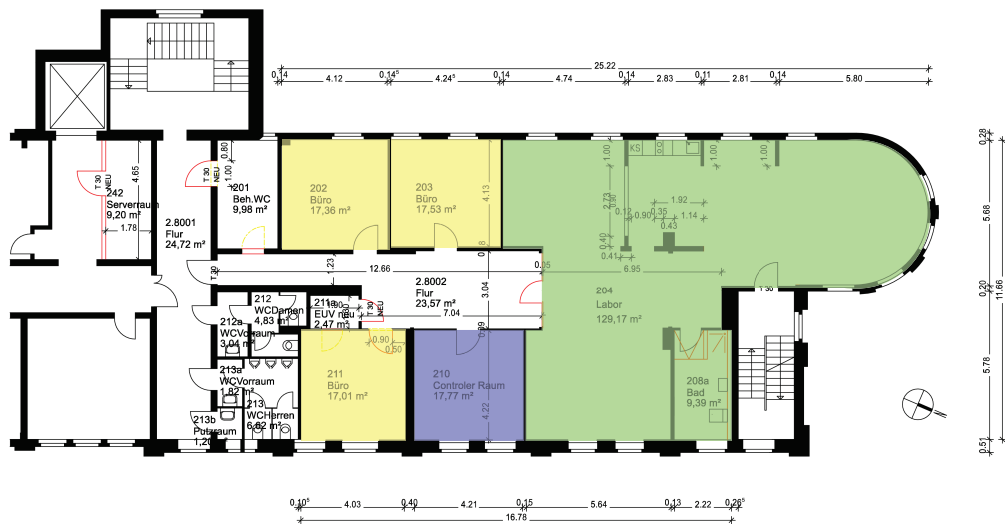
Living Place - Grundriss nach [Gregor u. a. \(2009\)](#)
